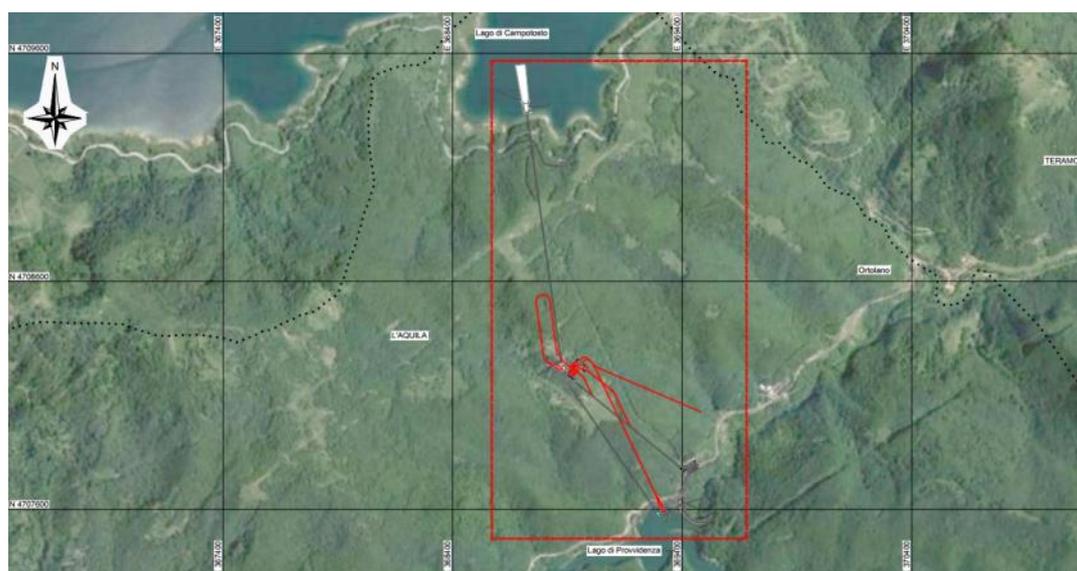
Estratto planimetrico generale su ortofoto delle opere in progetto (in rosso) e delle strutture esistenti (in grigio)
